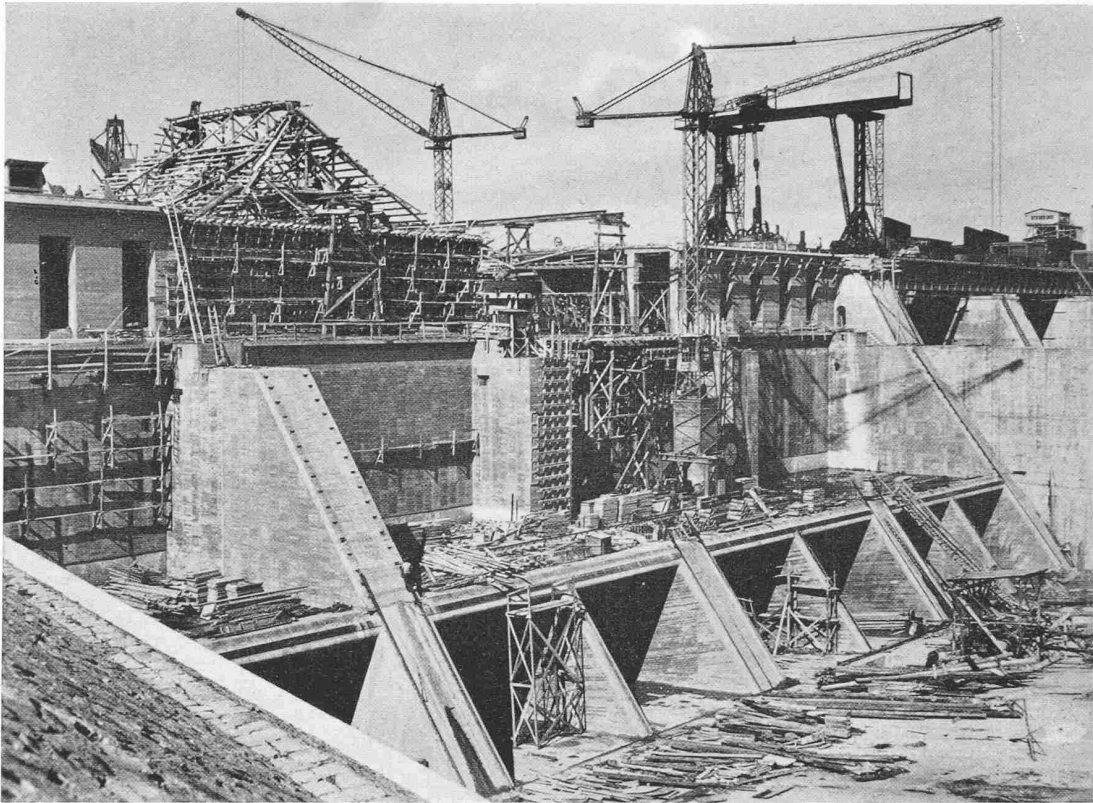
Krafthaus mit Betoniergerüst bei Turbine II
